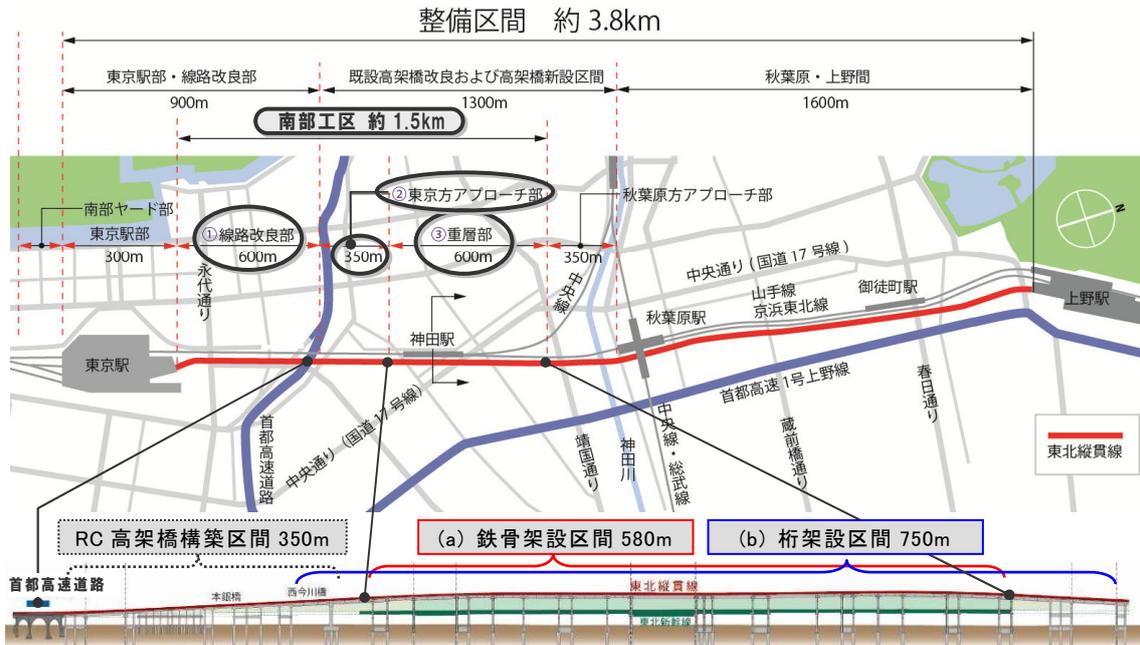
工事位置 平面図(上)と側面図(下) ※図の右側が北
